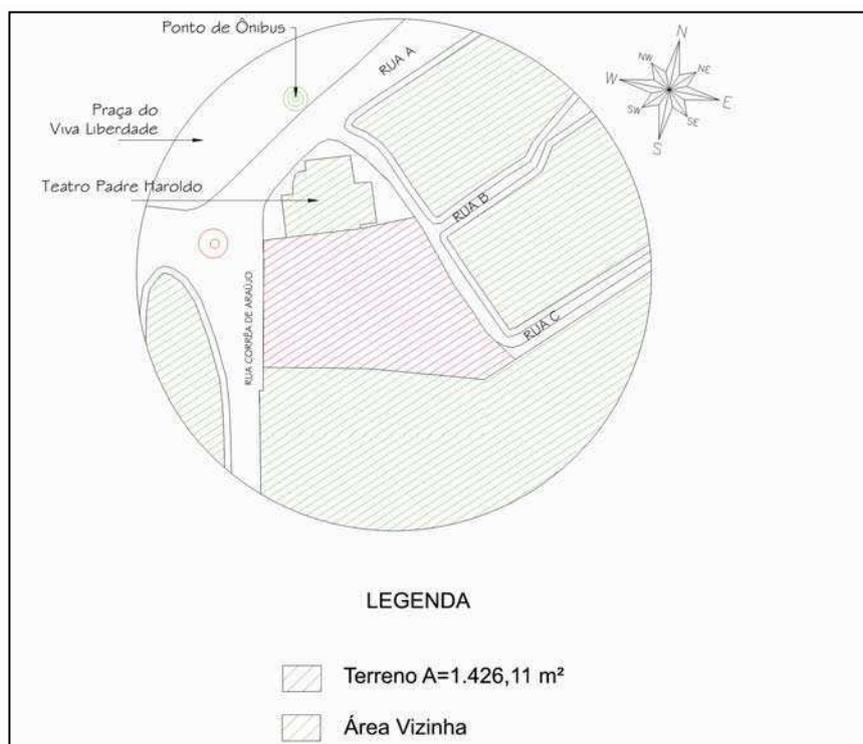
Terreno para implantação do anteprojeto da Creche-Escola
